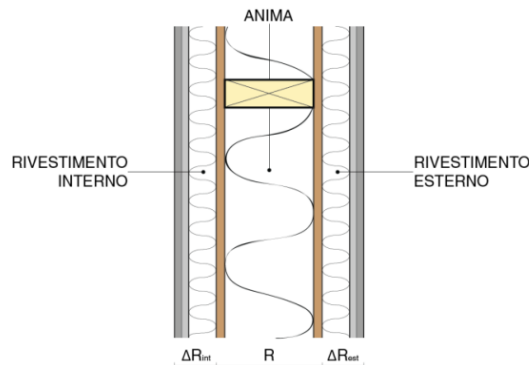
Schematizzazione della parete divisoria per il modello di calcolo - Layout of the separation wall for the calculation model.
